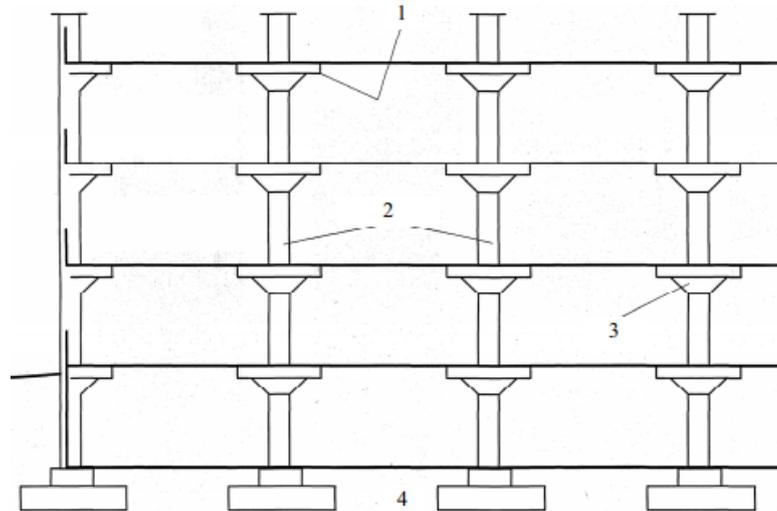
Железобетонное безбалочное перекрытие. 1 - платформа; 2 - колонна; 3 - капитель; 4 - фундамент.
